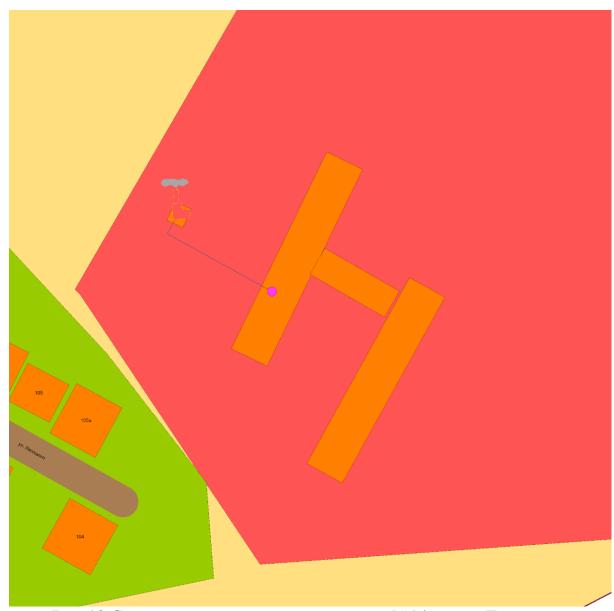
Схема тепловой сети от котельной №14 по ул. Лясоцкого
